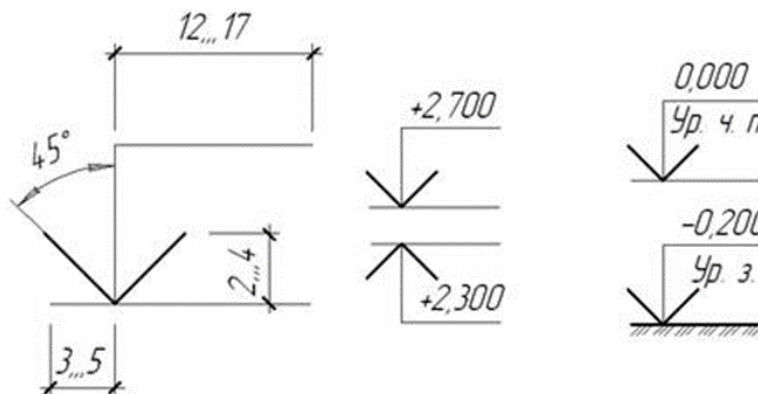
Пример выполнения отметок уровня на разрезах и фасадах
